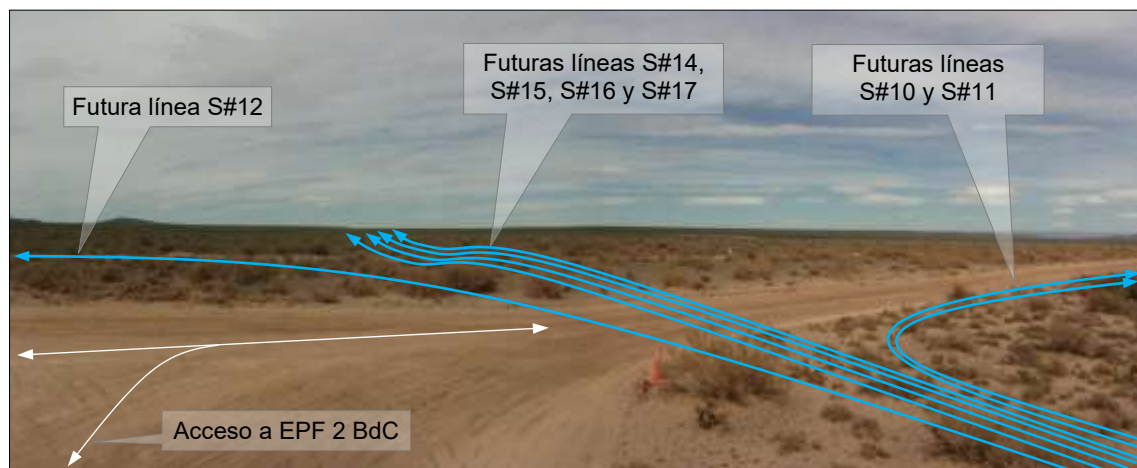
Vista en dirección Suroeste, desde el camino de acceso por el Sur a la EPF 2 BdC. Se observa el giro al Oeste de las trazas de las futuras líneas S#10 y S#11 paralelas al camino troncal existente, de acceso a la EPF 2. Las trazas de las futuras líneas S#14, S#15, S#16 y S#17 cruzan el camino troncal y continúan al Sur por terreno natural, mientras que la futura traza de la línea S#12, cruza el mencionado camino y continúa al Este paralelo al mismo. Coordenadas x: 5834617; y: 2486456.
